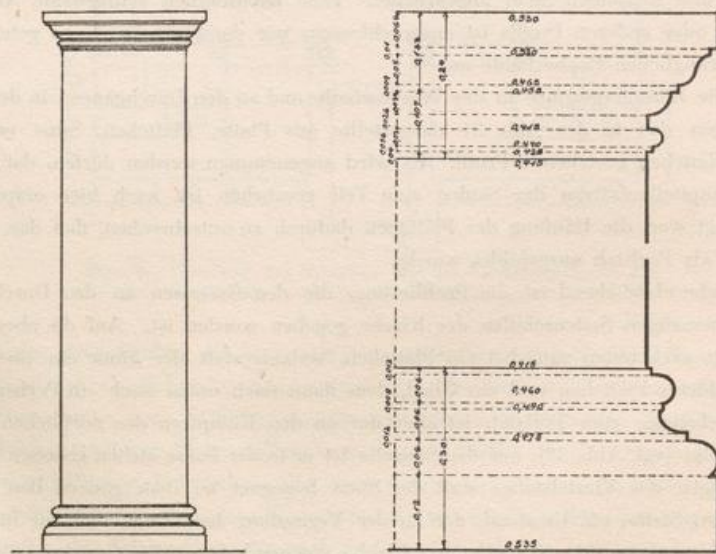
Pfeiler mit Rundstabprofil im Erdgeschoß des Westwerkes
